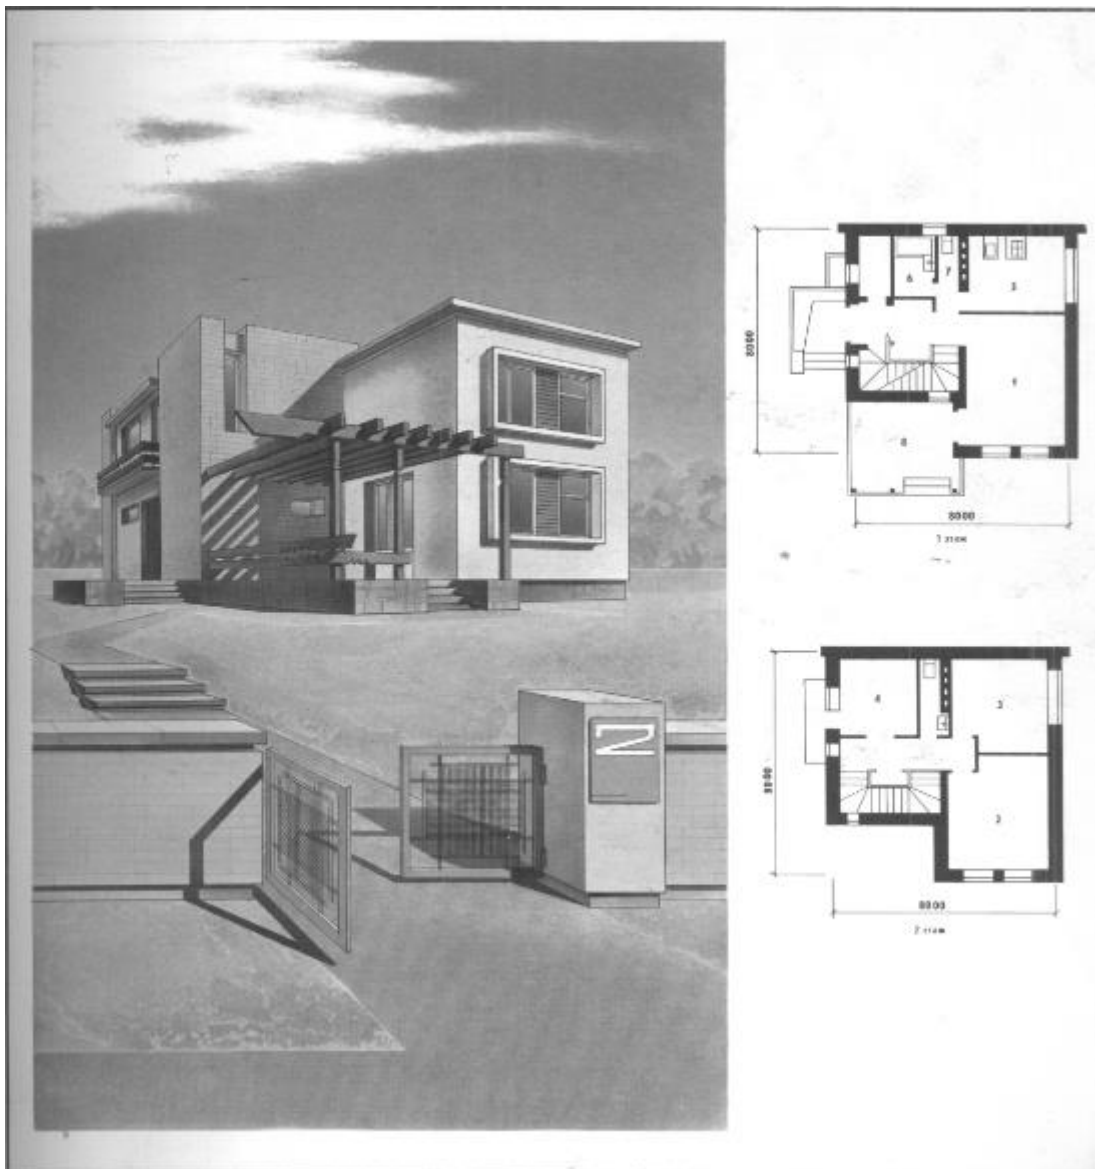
Двухэтажный многоквартирный 4-комнатный жилой дом (типовой проект, разработан ЦЧОгипросельхозстроем).
